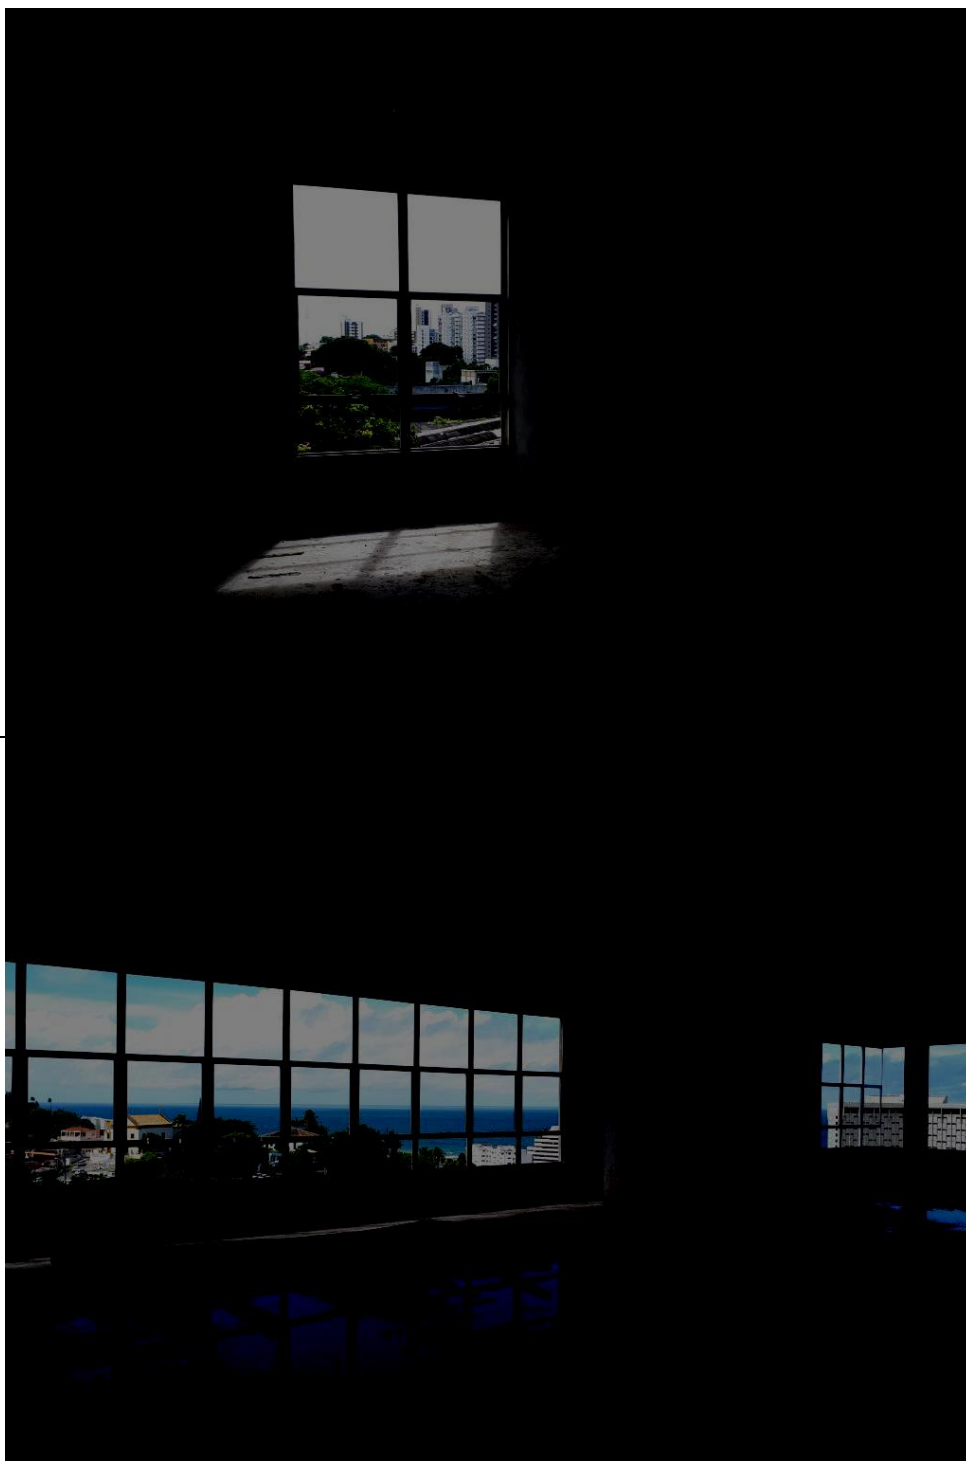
Vista da chegada no terceiro andar. Detalhe da drenagem pluvial executada.
